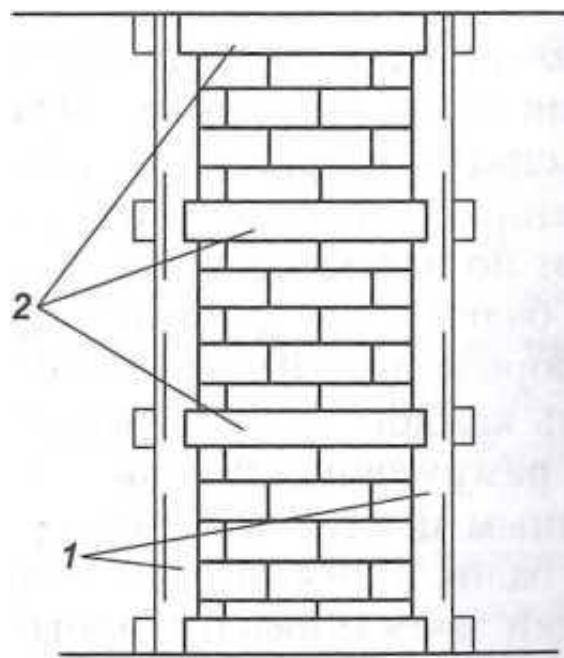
Установка съемной опалубки для усиления кирпичной кладки простенка железобетонной обоймой
